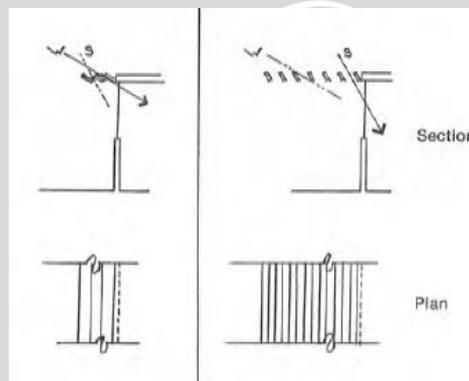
Horizontal *shading device* The Alcoa Building in Pittsburgh,
